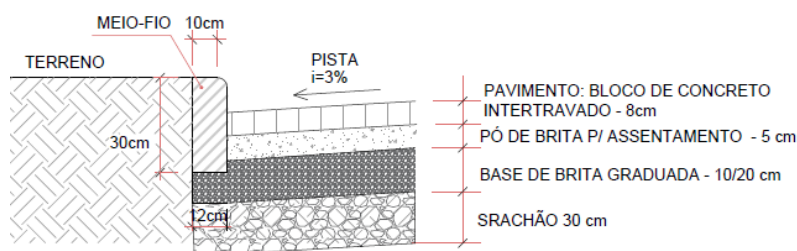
Corte Transversal – Bloco Intertravado 8 cm
